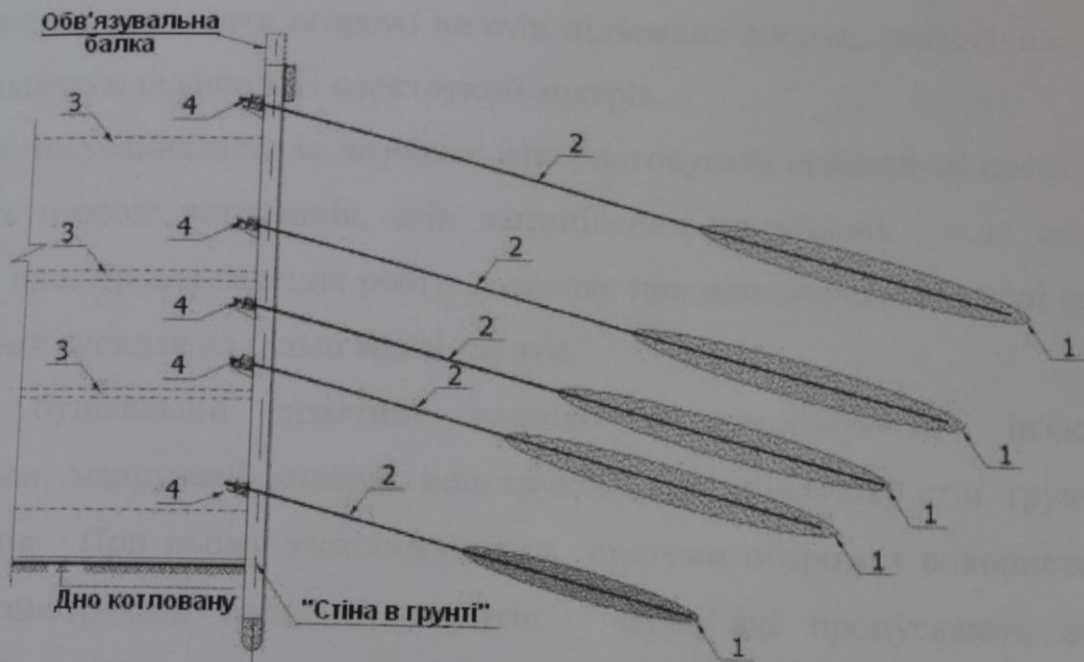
Огороджувальна конструкція укріплення глибокого котловану із застосуванням ґрунтових анкерів: 1 – закладення анкера; 2 – вільна частина; 3 – перекриття, що влаштовуються; 4 – оголовок анкера.
